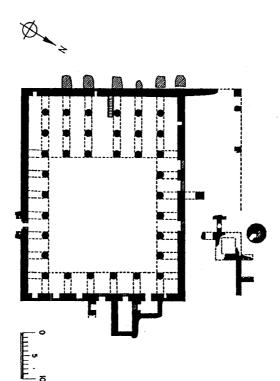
مسقط أفقي لمسجد Adina (شكل ٢٧٨ مسقط أفقي لمسجد ٢٧٧هم في باندوا (غرب البنغال) (عن ، جورج ميشيل) .
